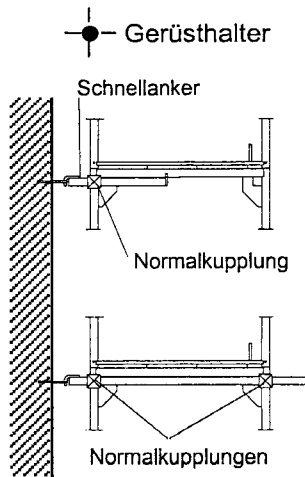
Unbekleidetes Gerüst, Grundvariante, $L \leq 2.57$ m
